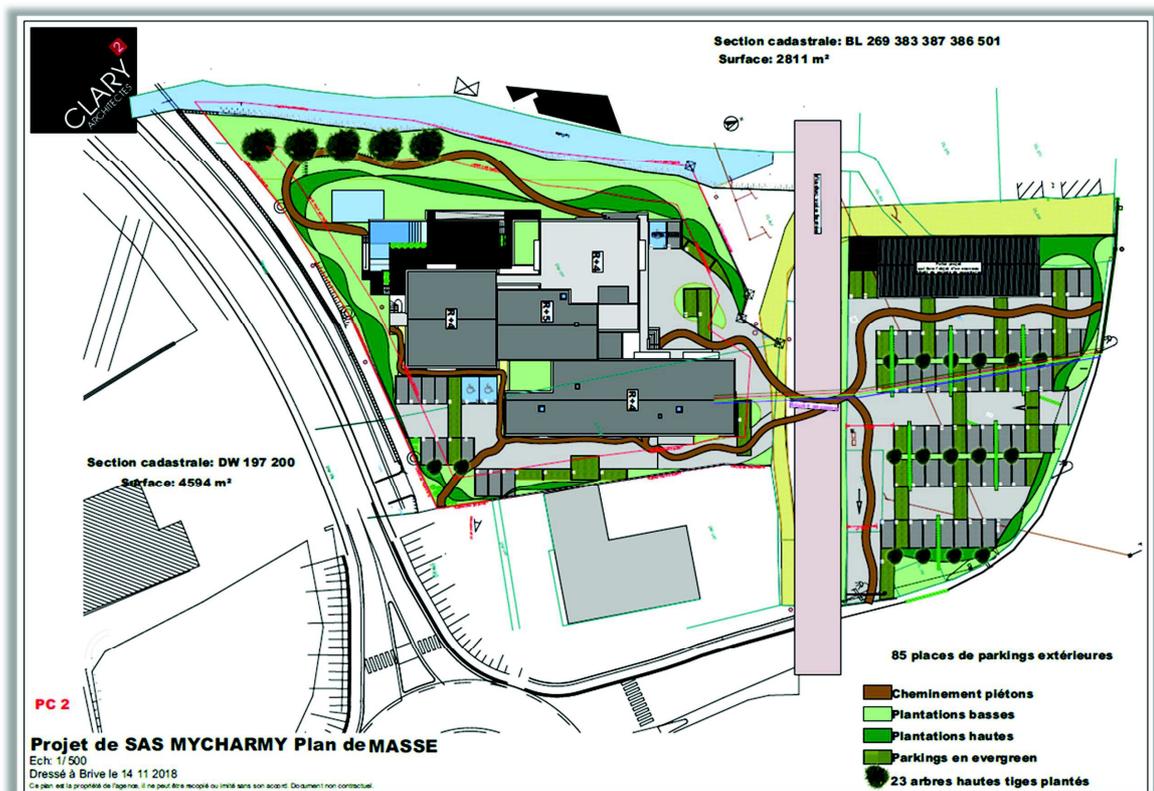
Plan du projet de création des deux hôtels - Clary architecte
